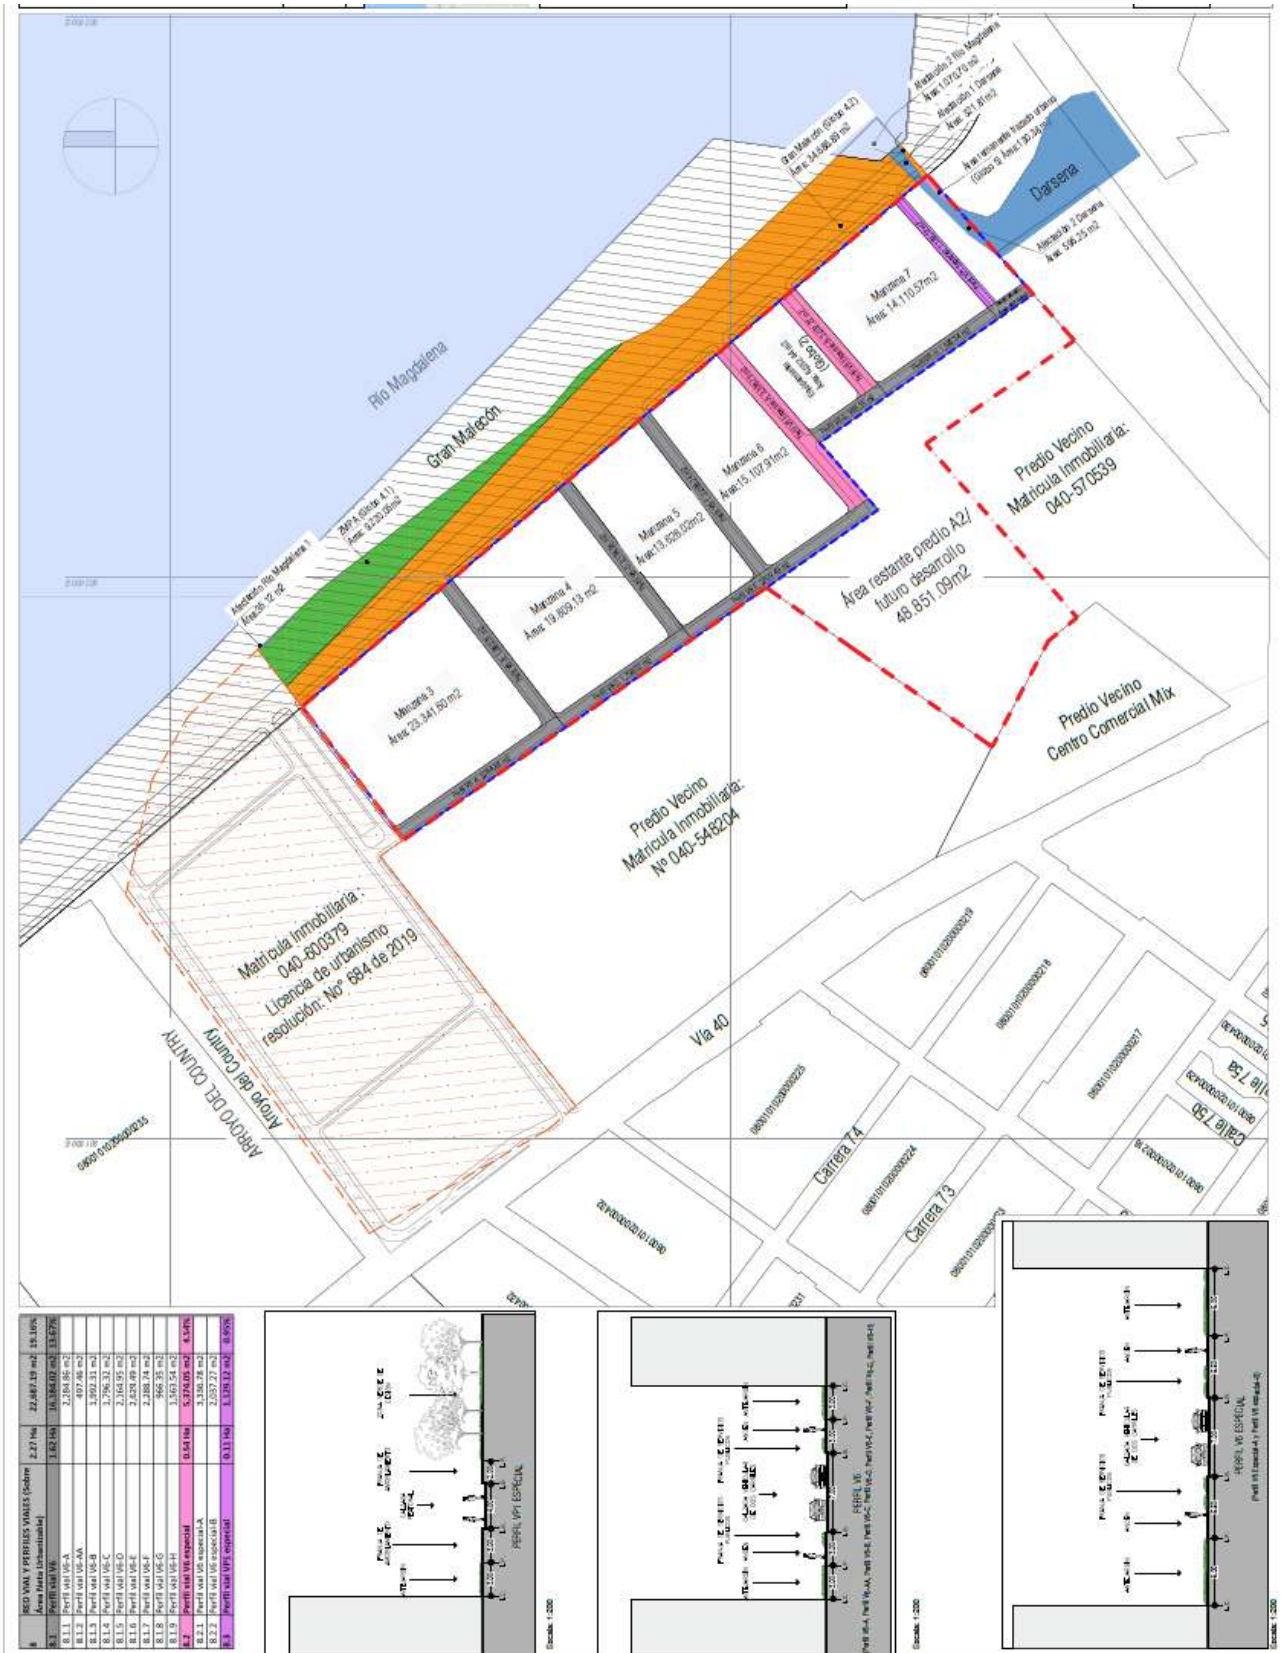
Propuesta de red vial y perfiles viales Plan Parcial Magdalena. Ver plano anexo F-002.
